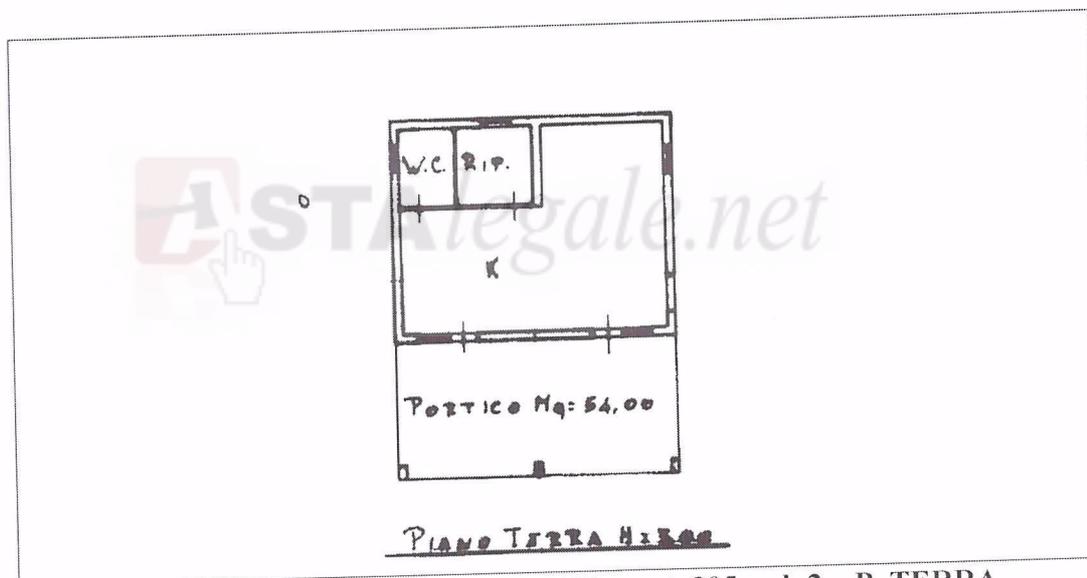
planimetria U.I.U., fg. 178, part. 305, sub 2 – P. TERRA
